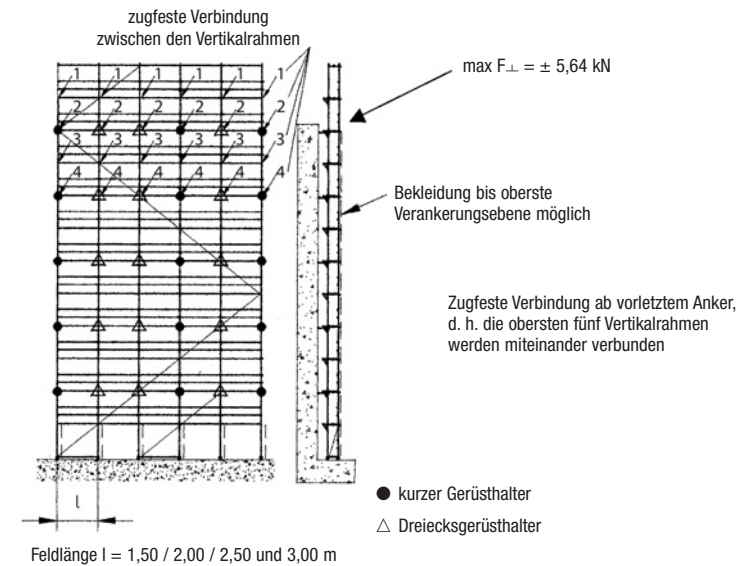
Über der letzten Verankerung freistehende Gerüstlagen; Gerüst mit Netzen bedeckt und mit Innenkonsolen vor offener Fassade
